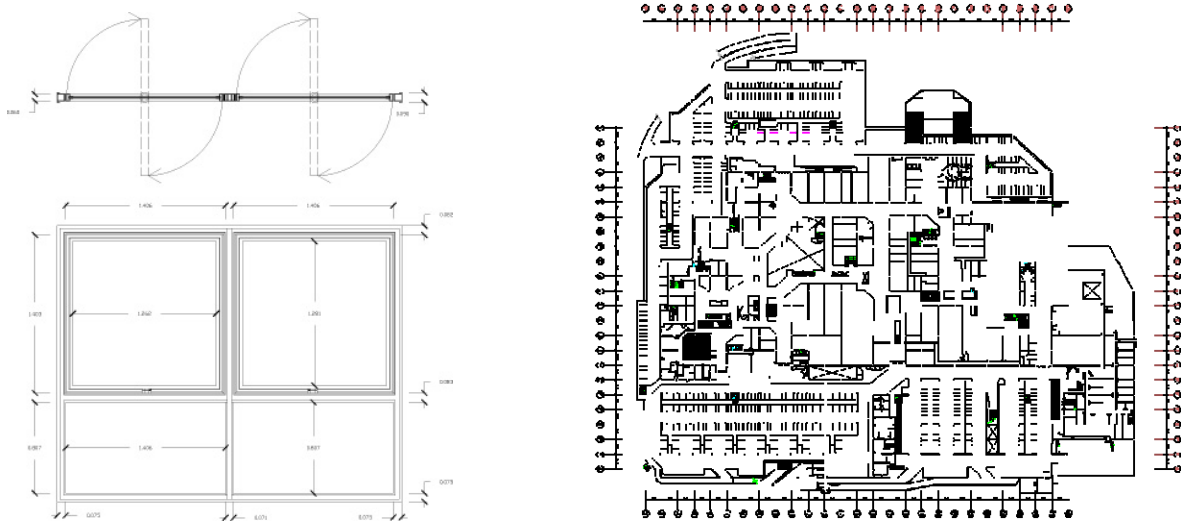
Detalle de ventana y planta del Nivel C1
